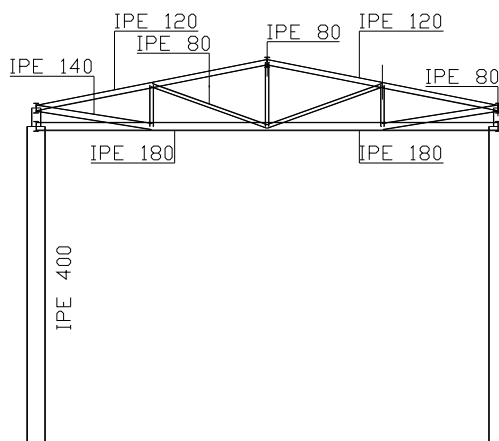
Pórtico com pilar de alma cheia, viga em treliça, vão de 10.00m, pilar e viga em perfil com secção transversal IPE.
